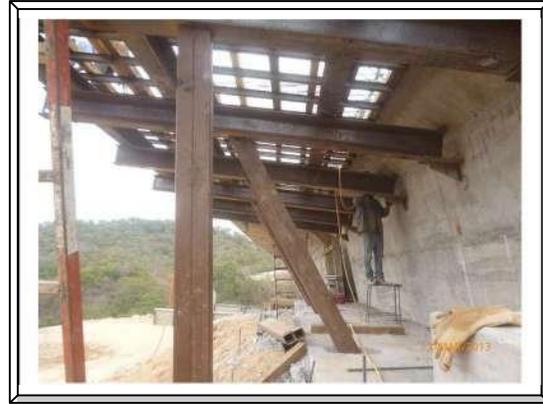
Apuntalamiento en volado de losa superior de dovela de orilla.
